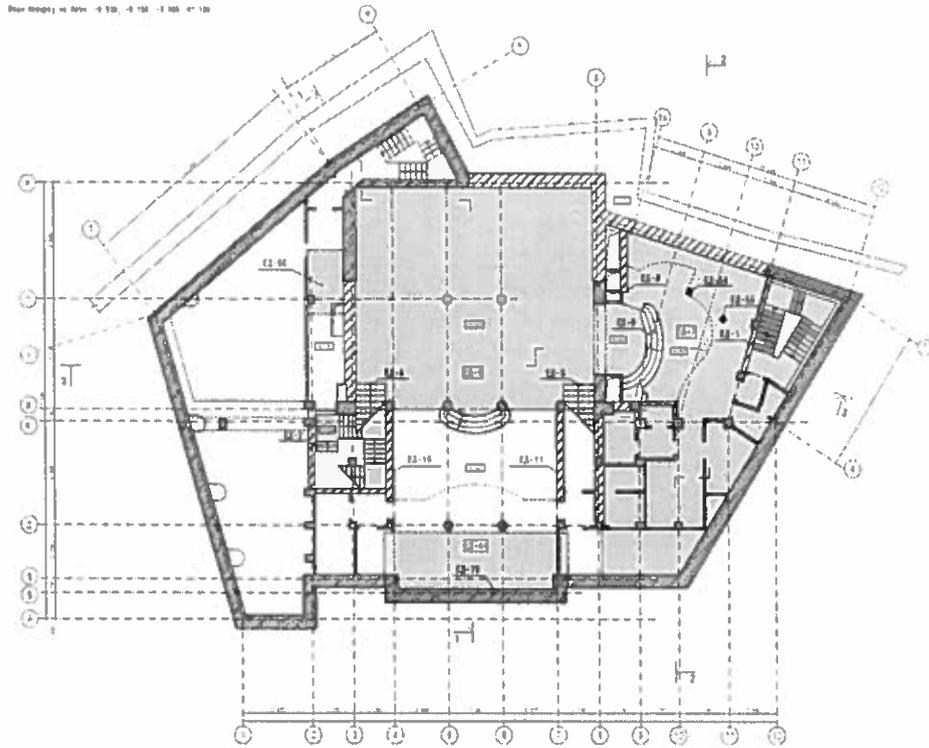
План будівлі на відмітці -6,500, -6,150, -5,900 [2]
